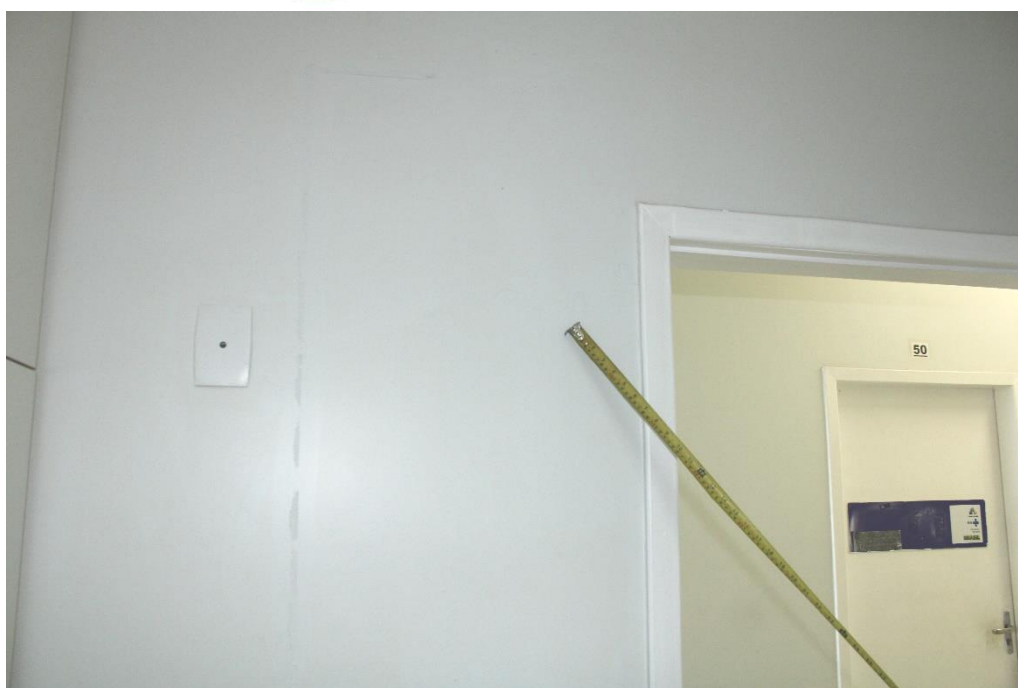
Vista parcial da sala 51, destacando fissura horizontal em alvenaria.
